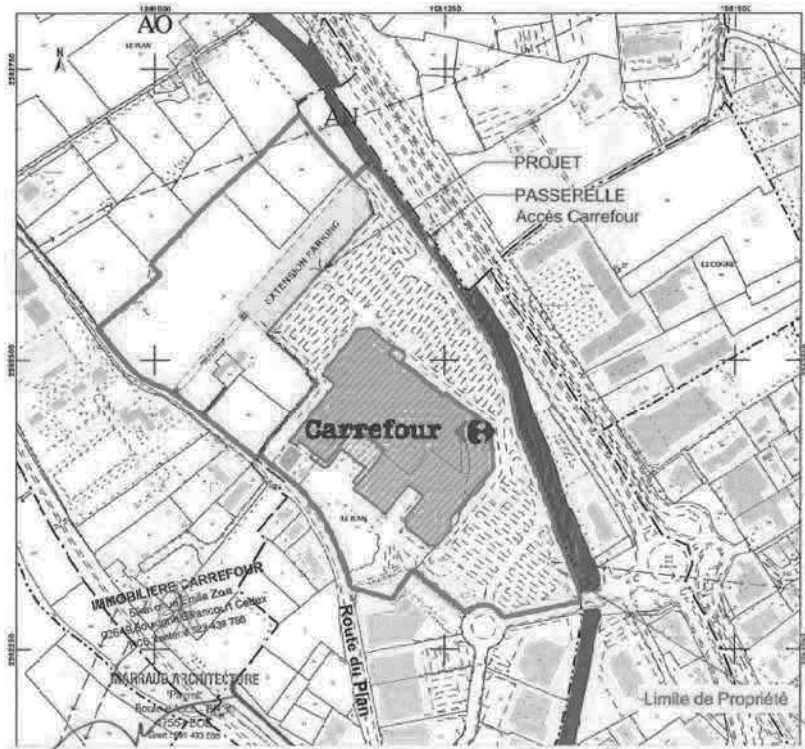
Localisation du site sur fond cadastral et zoom sur l'extension du parking
